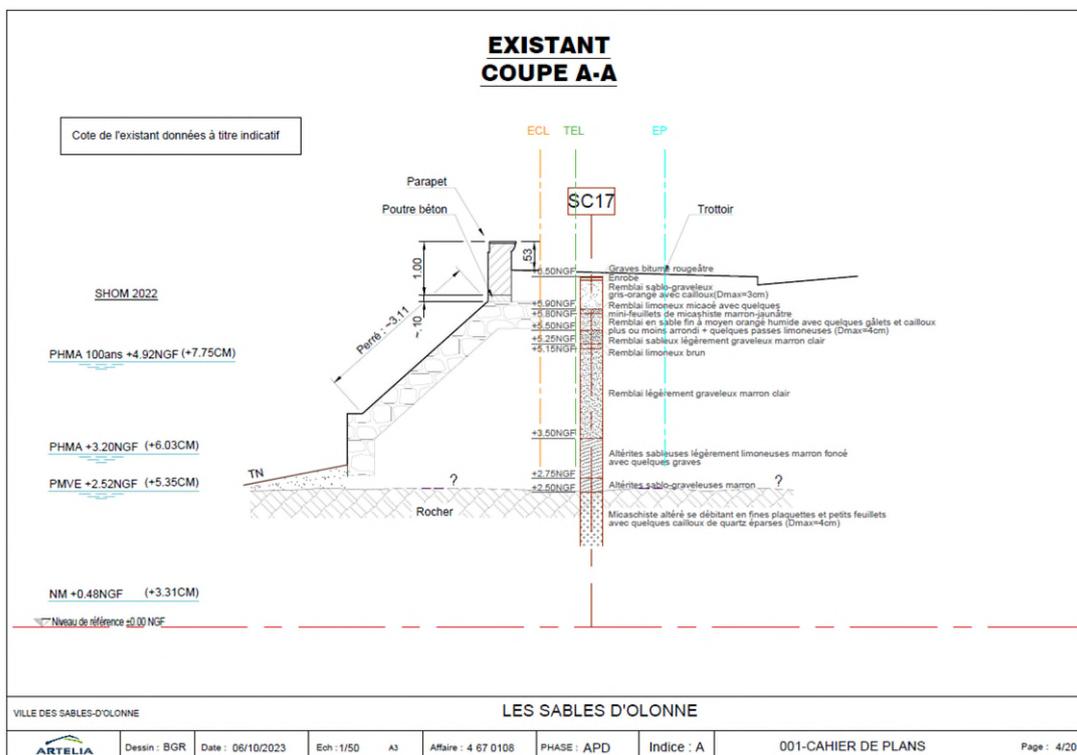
Vue en coupe des ouvrages existant au droit du sondage SC17 (secteur C)
